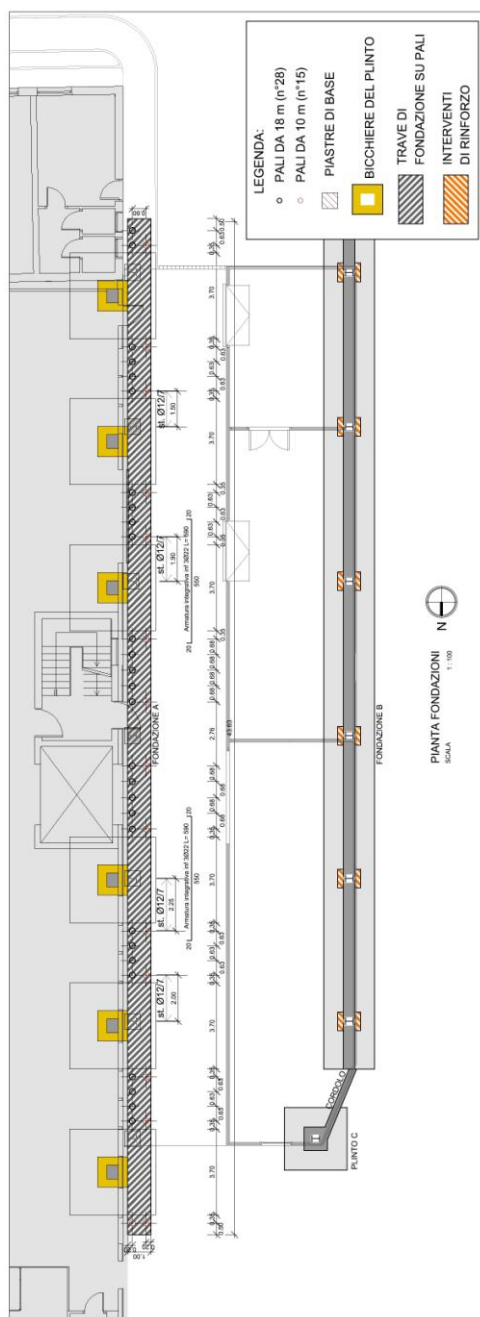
Particolare di A.2006.a.us.T02 - Pianta e particolari fondazioni - Pianta
